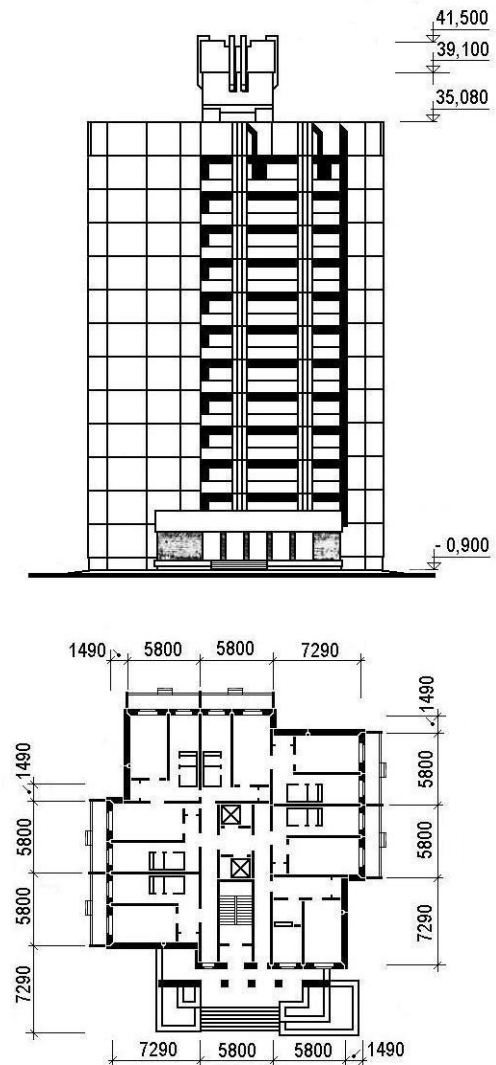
60. БелНИИПроградостроительства (Новополоцк). 12-этажный 83-квартирный крупнопанельный жилой дом для малосемейных. Схемы фасада и плана 1 этажа
